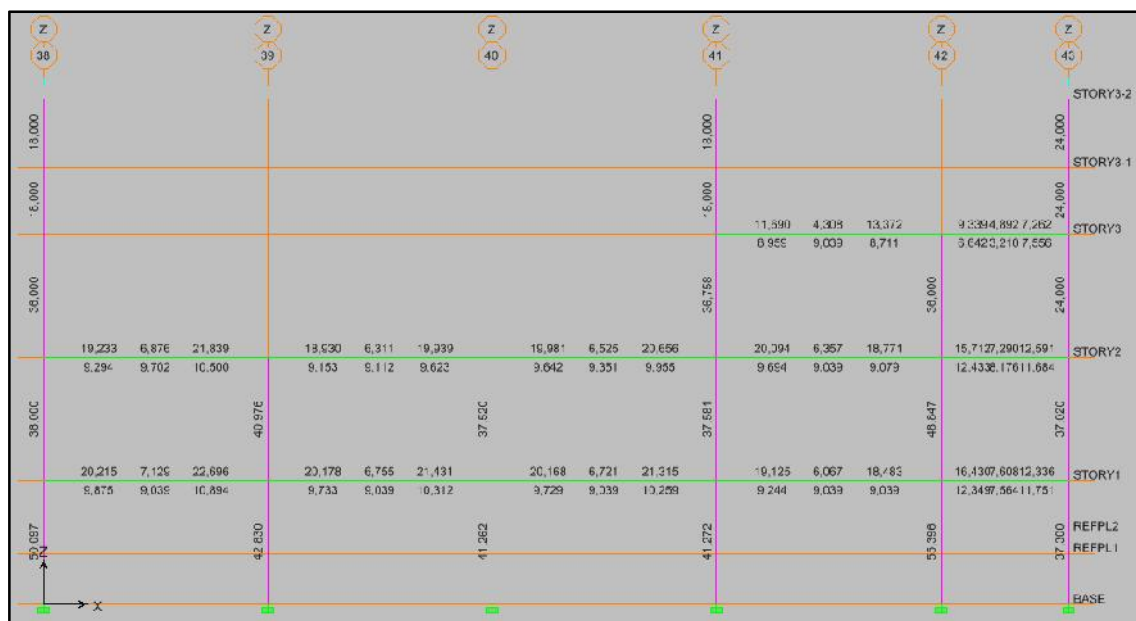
Acero en vigas pórtico Z, Consulta Externa II
